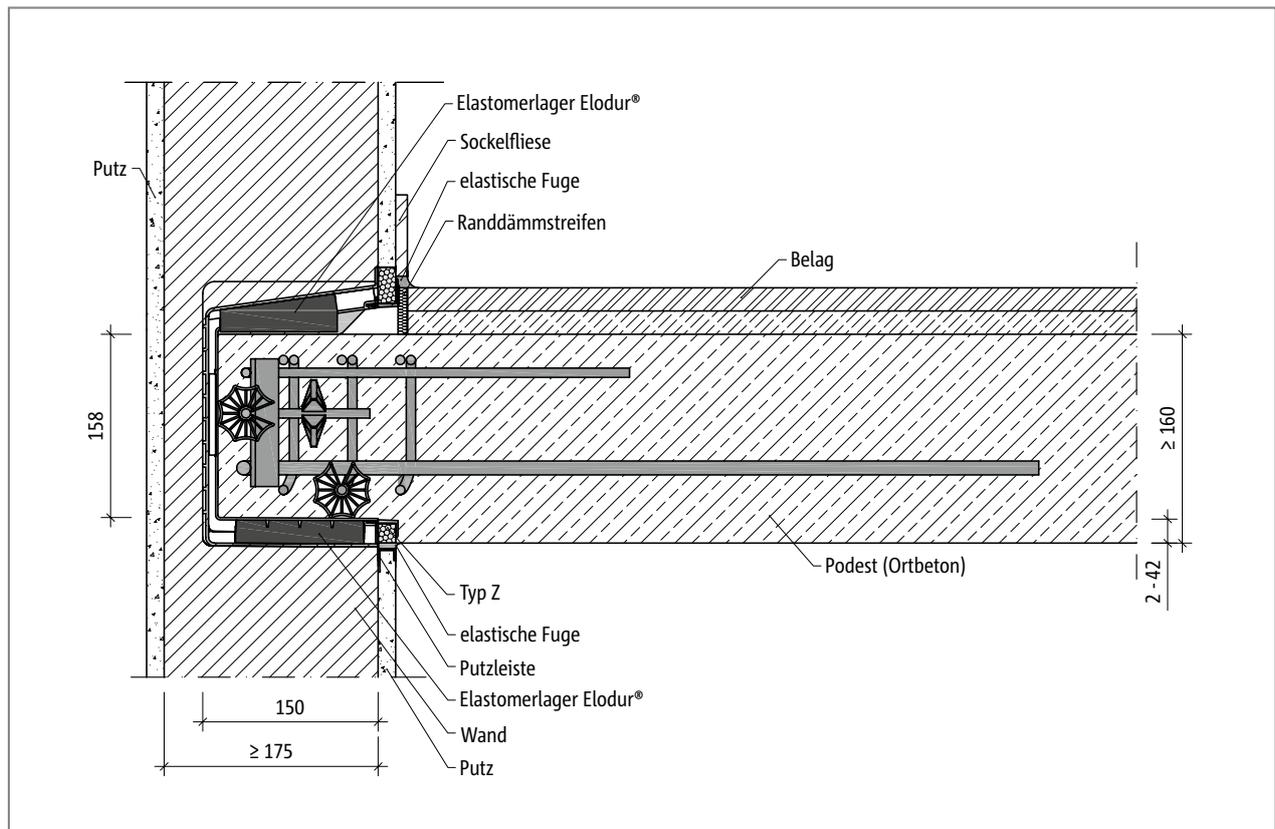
Schöck Tronsole® Typ Z-V+V-T: Einbauschnitt Ortbetonpodest
